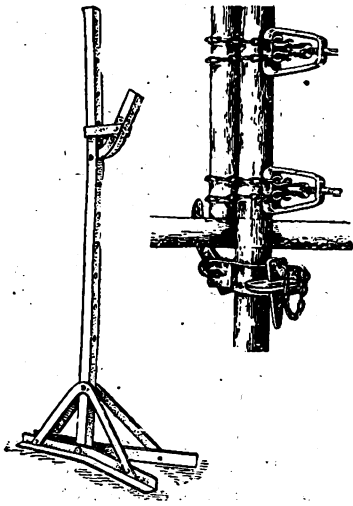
/2. Leicht verstellbarer Gerüstständer und Bindegeräte für Gerüste.
